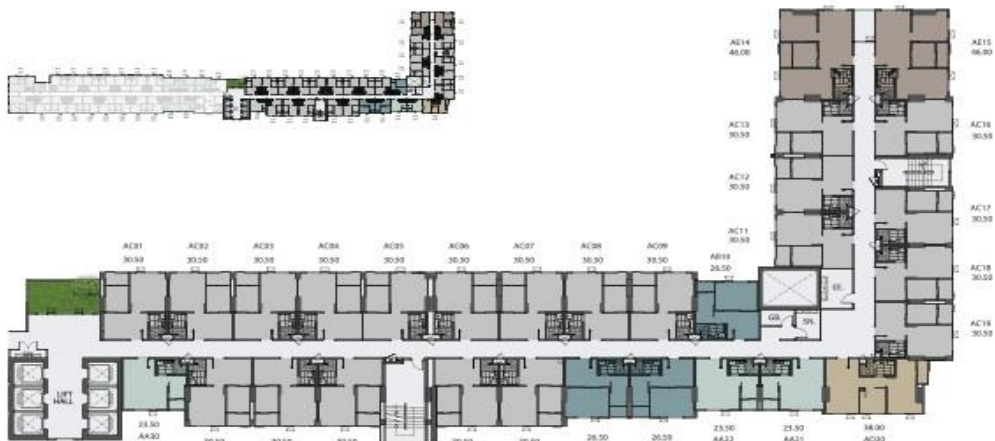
ผังรวม (Master Plan) ของโครงการแอสปาย สาธร-ท่าพระ
